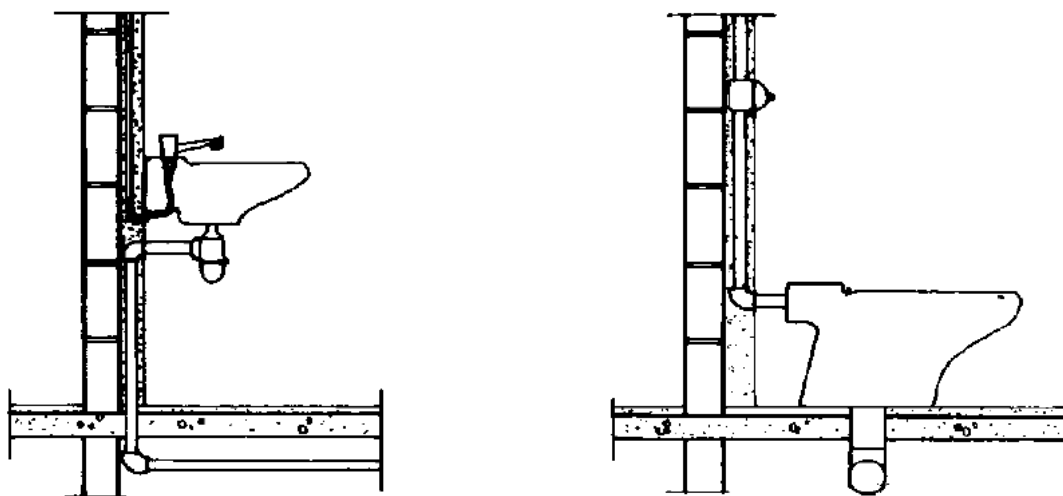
Detalhe de instalação hidráulica com enchimento (rebaixo feito com parede e menor espessura). Fonte: VIOLANI, 1992.
